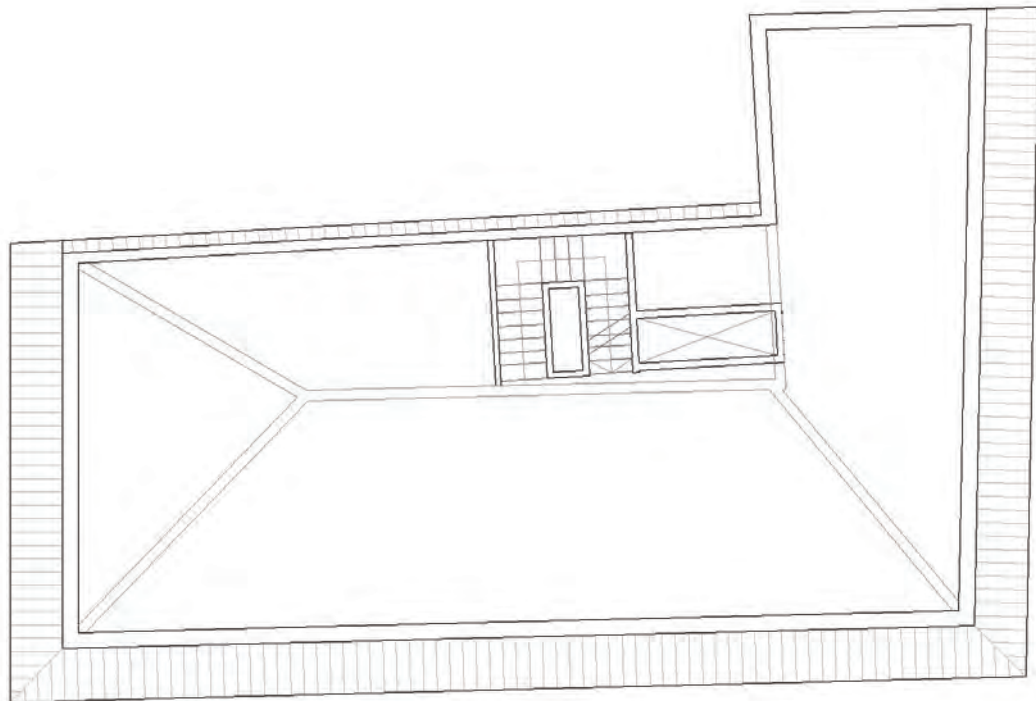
15. PLANTA BAJO CUBIERTA
